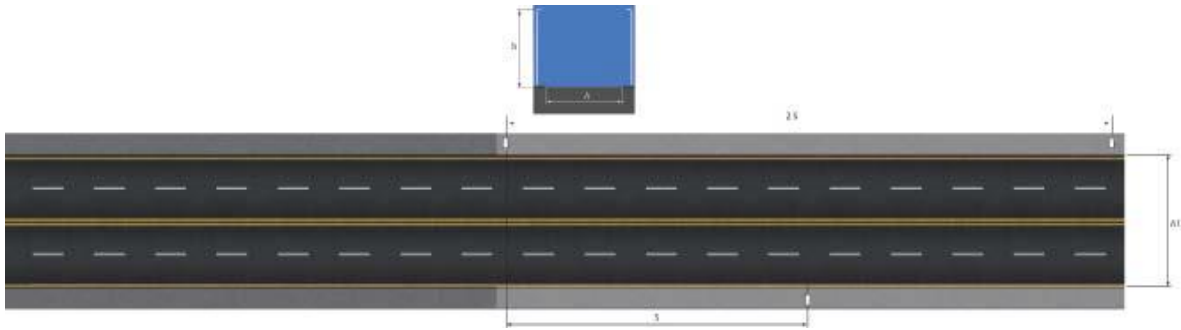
Vista de planta (Fuente Manual de iluminación vial SCyT).
